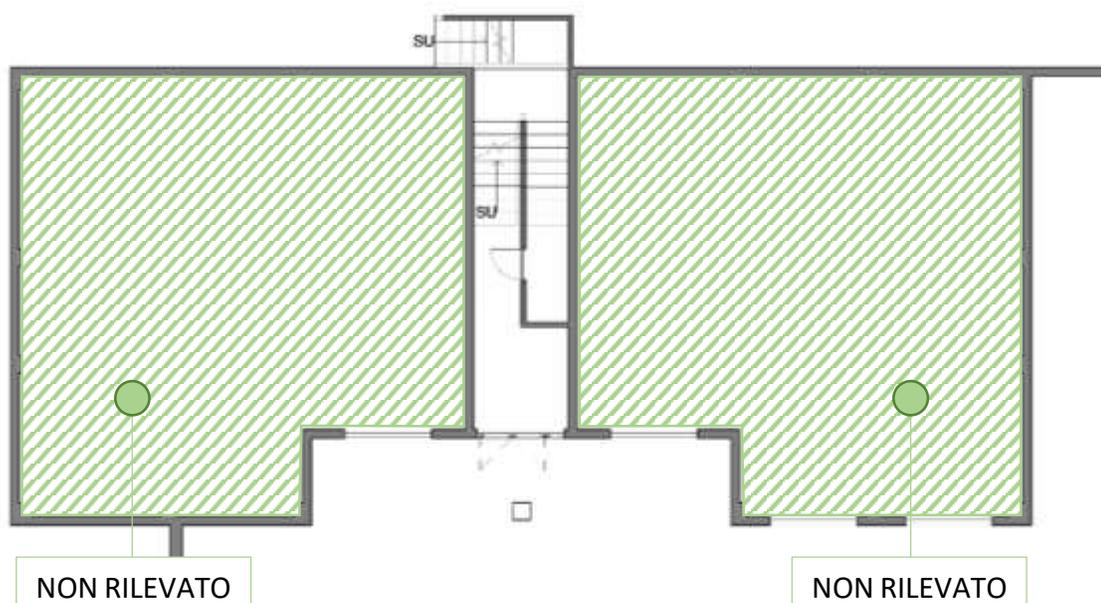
CASO STUDIO – PIANTA DEL PIANO TERRA
